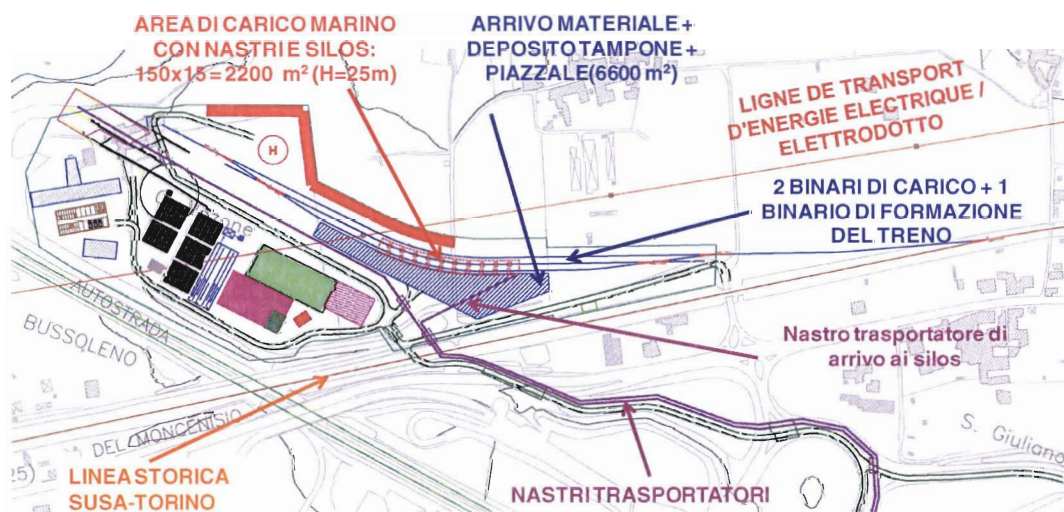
Area di carico di Susa: soluzione 1 (imbocco est Tunnel di Base): stralcio planimetrico
